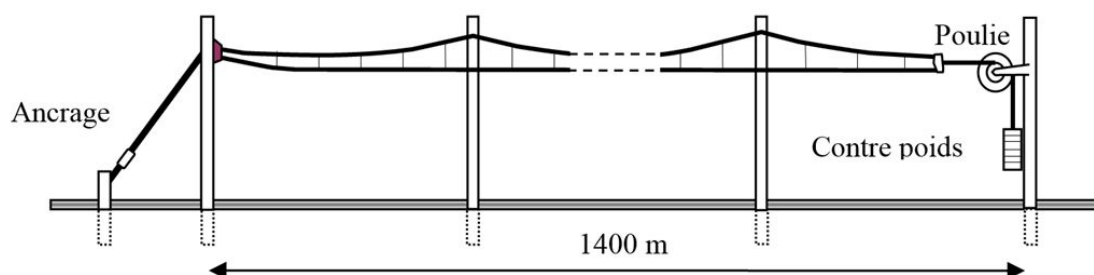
Illustration du système de tension sur une section de 1400 m.
